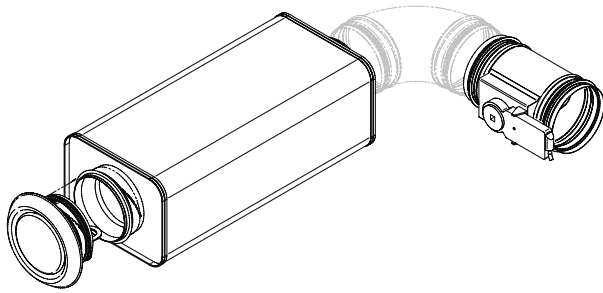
Tilluftkit PARAGON T-SAK-VAV-125
